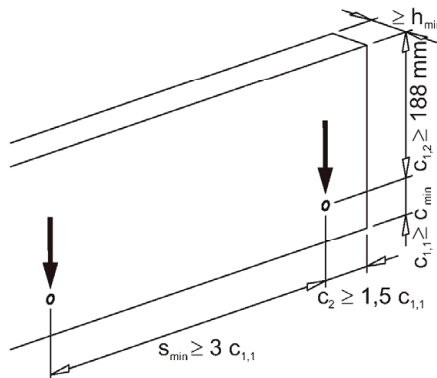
Einbausituation Wandfläche - Querbeanspruchung mit Betonkantenbruch, ohne Rückhängbewehrung
